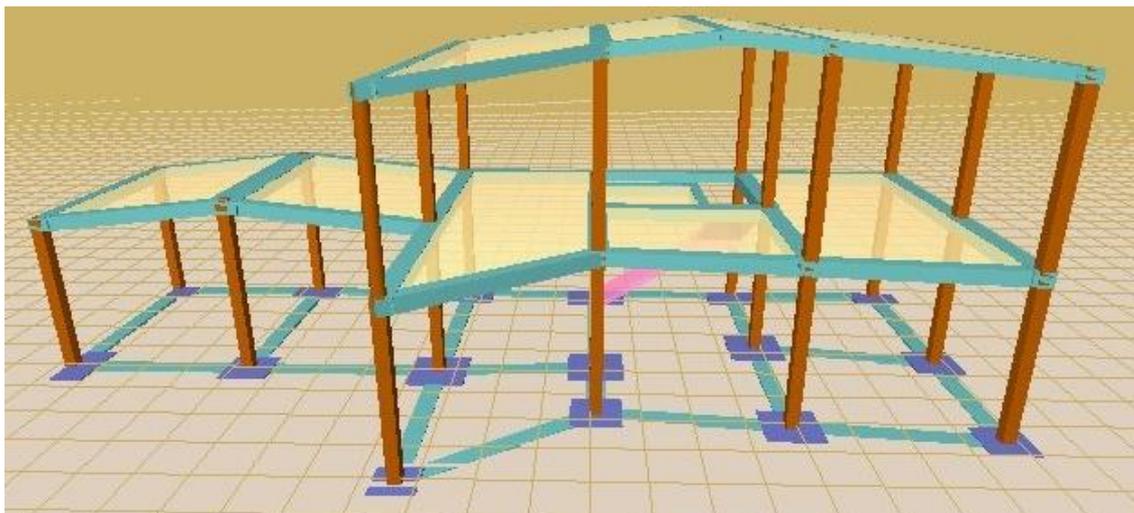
planta en alzado de la estructura de la zona de oficinas
